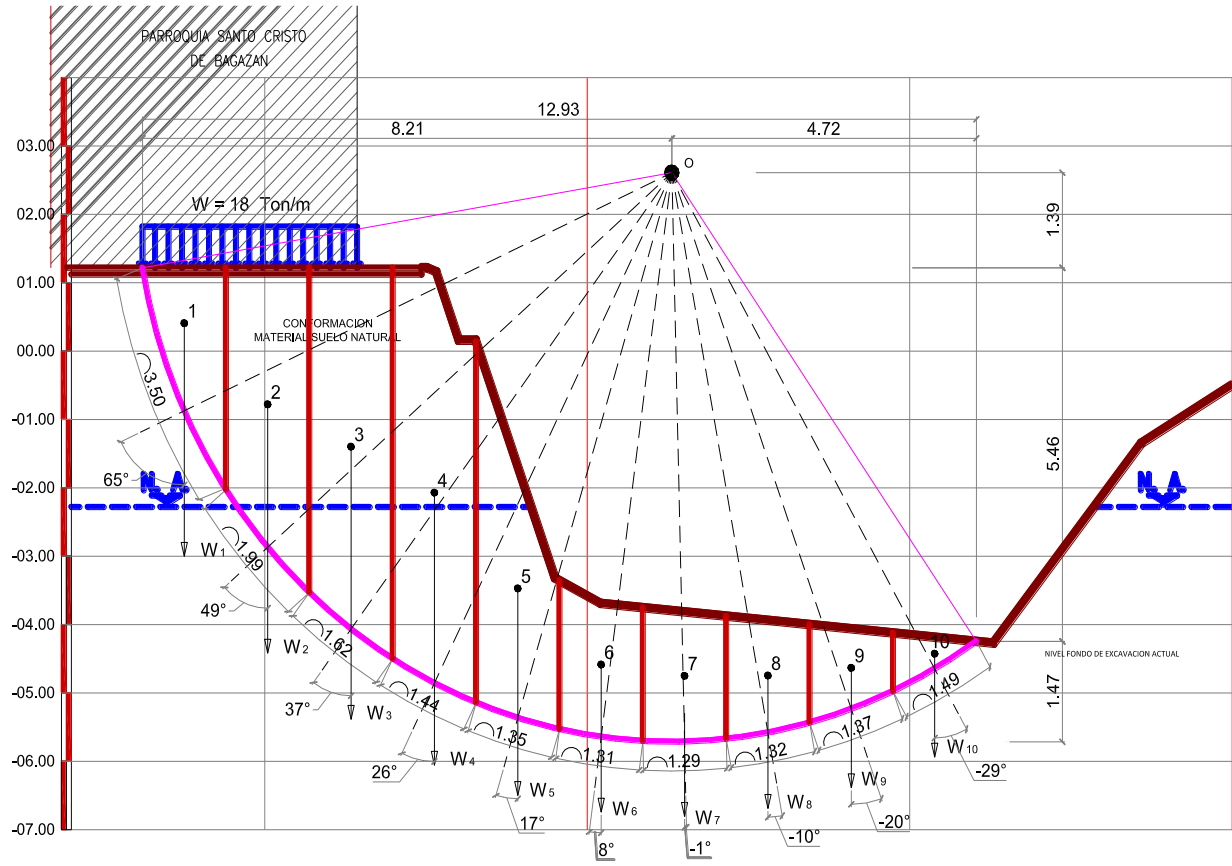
Plano de falla 2 estabilizado con el modelo propuesto.
